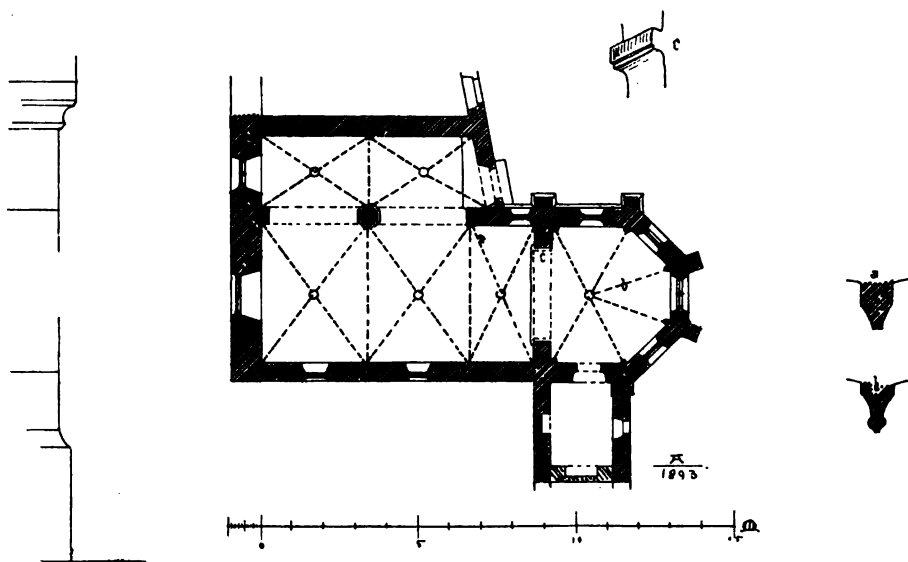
Zülrich. Grundriss der Gasthauskapelle.
